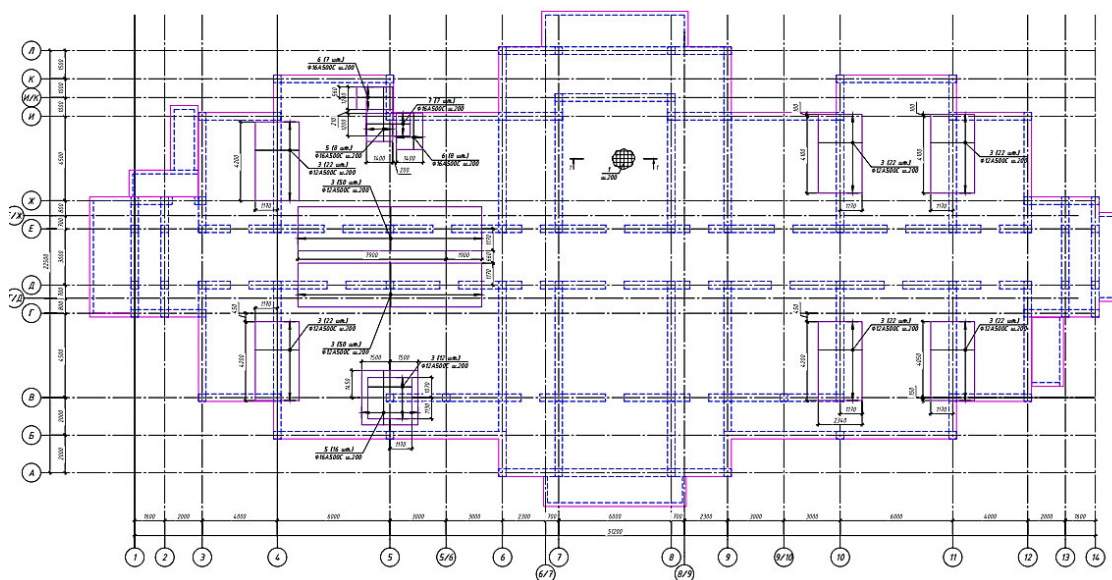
Схема раскладки нижней арматуры фундаментной плиты
